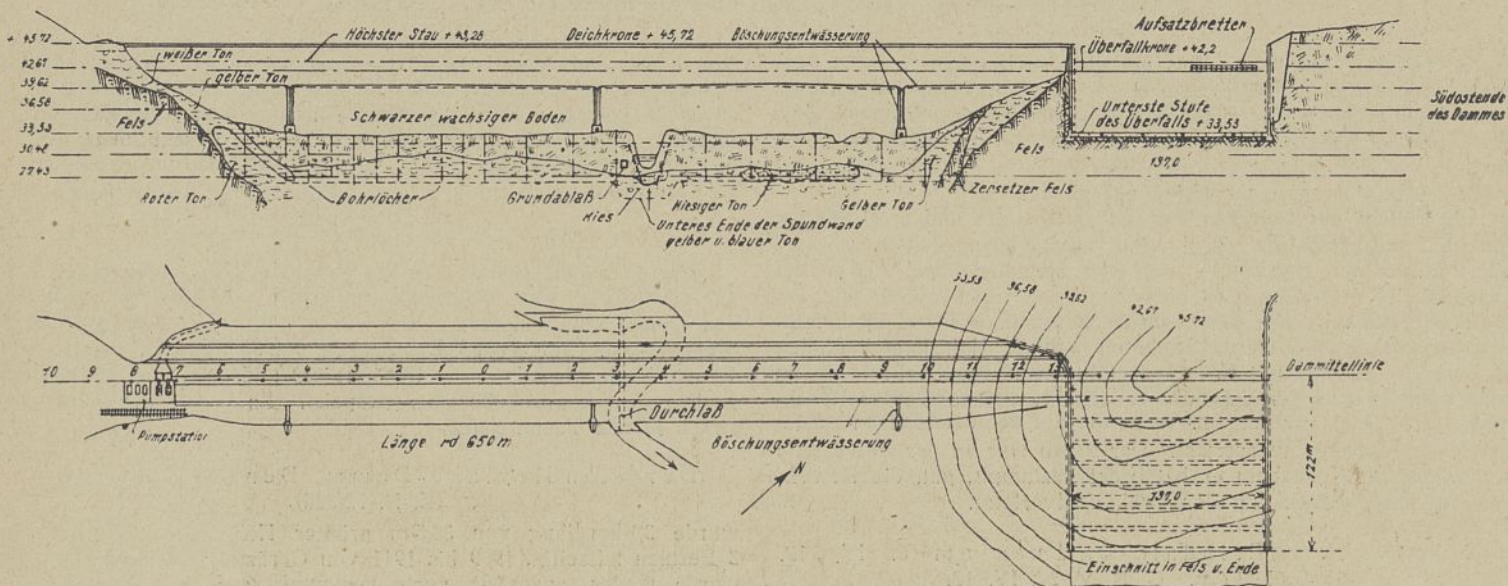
und 10. Dallas-Damm, luftseitige Ansicht und Grundriß.
